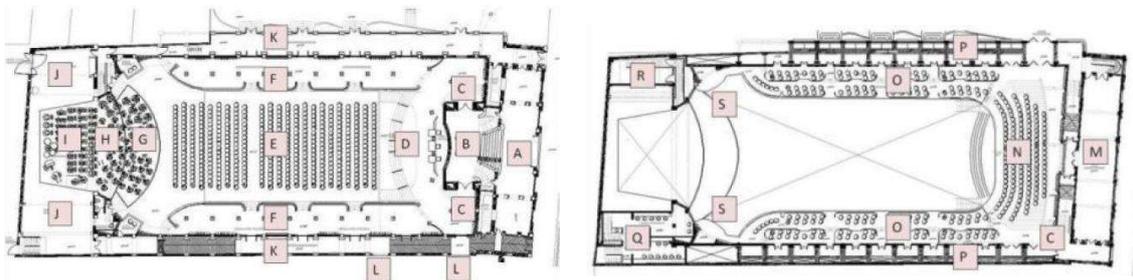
Planta Baixa Primeiro Pavimento do Teatro Faenza.
